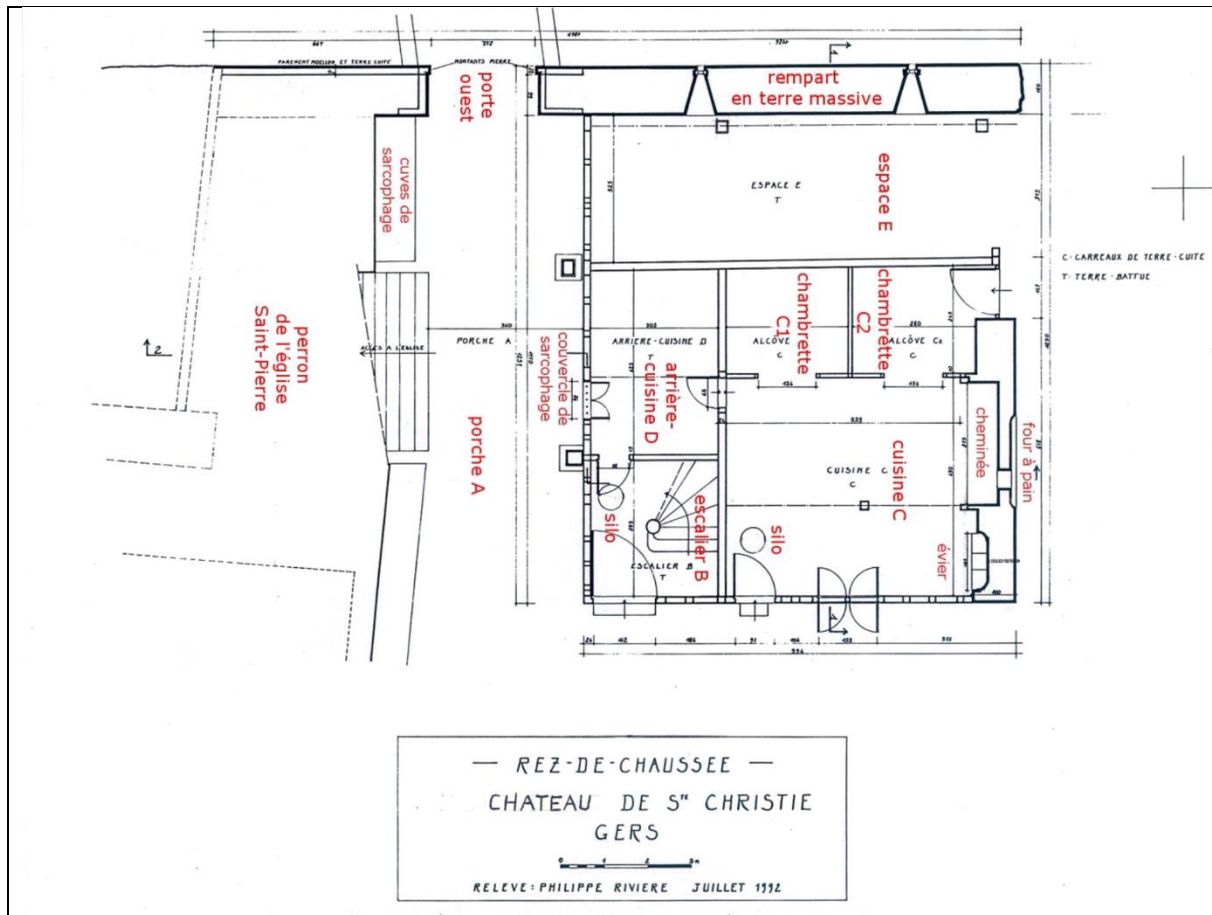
Plan du rez-de-chaussée du logis à pan de bois (relevé : Ph. Rivière, A. Klein)
